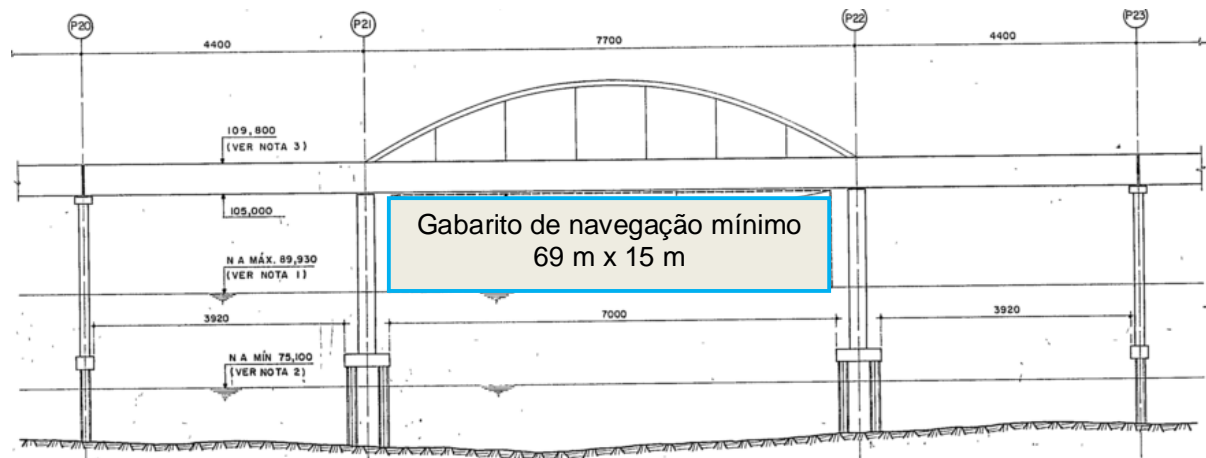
Vista longitudinal do trecho 3 contemplando arco metálico e gabarito para navegação
